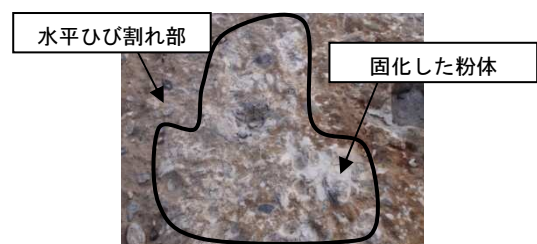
未洗浄時の水平ひび割れ部の状態（試験体C）
